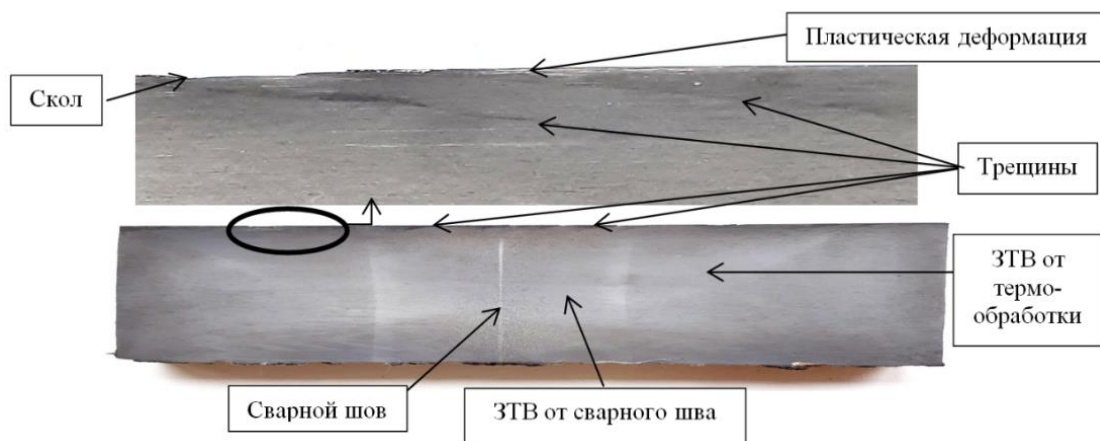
Макроструктура сварного соединения рельса, сваренного контактным способом
